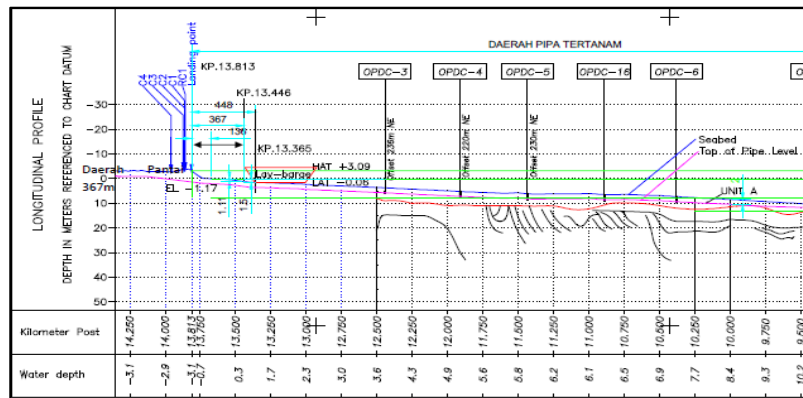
Posisi Pipa dan Bentuk Parit Tanpa Sheet Pile
